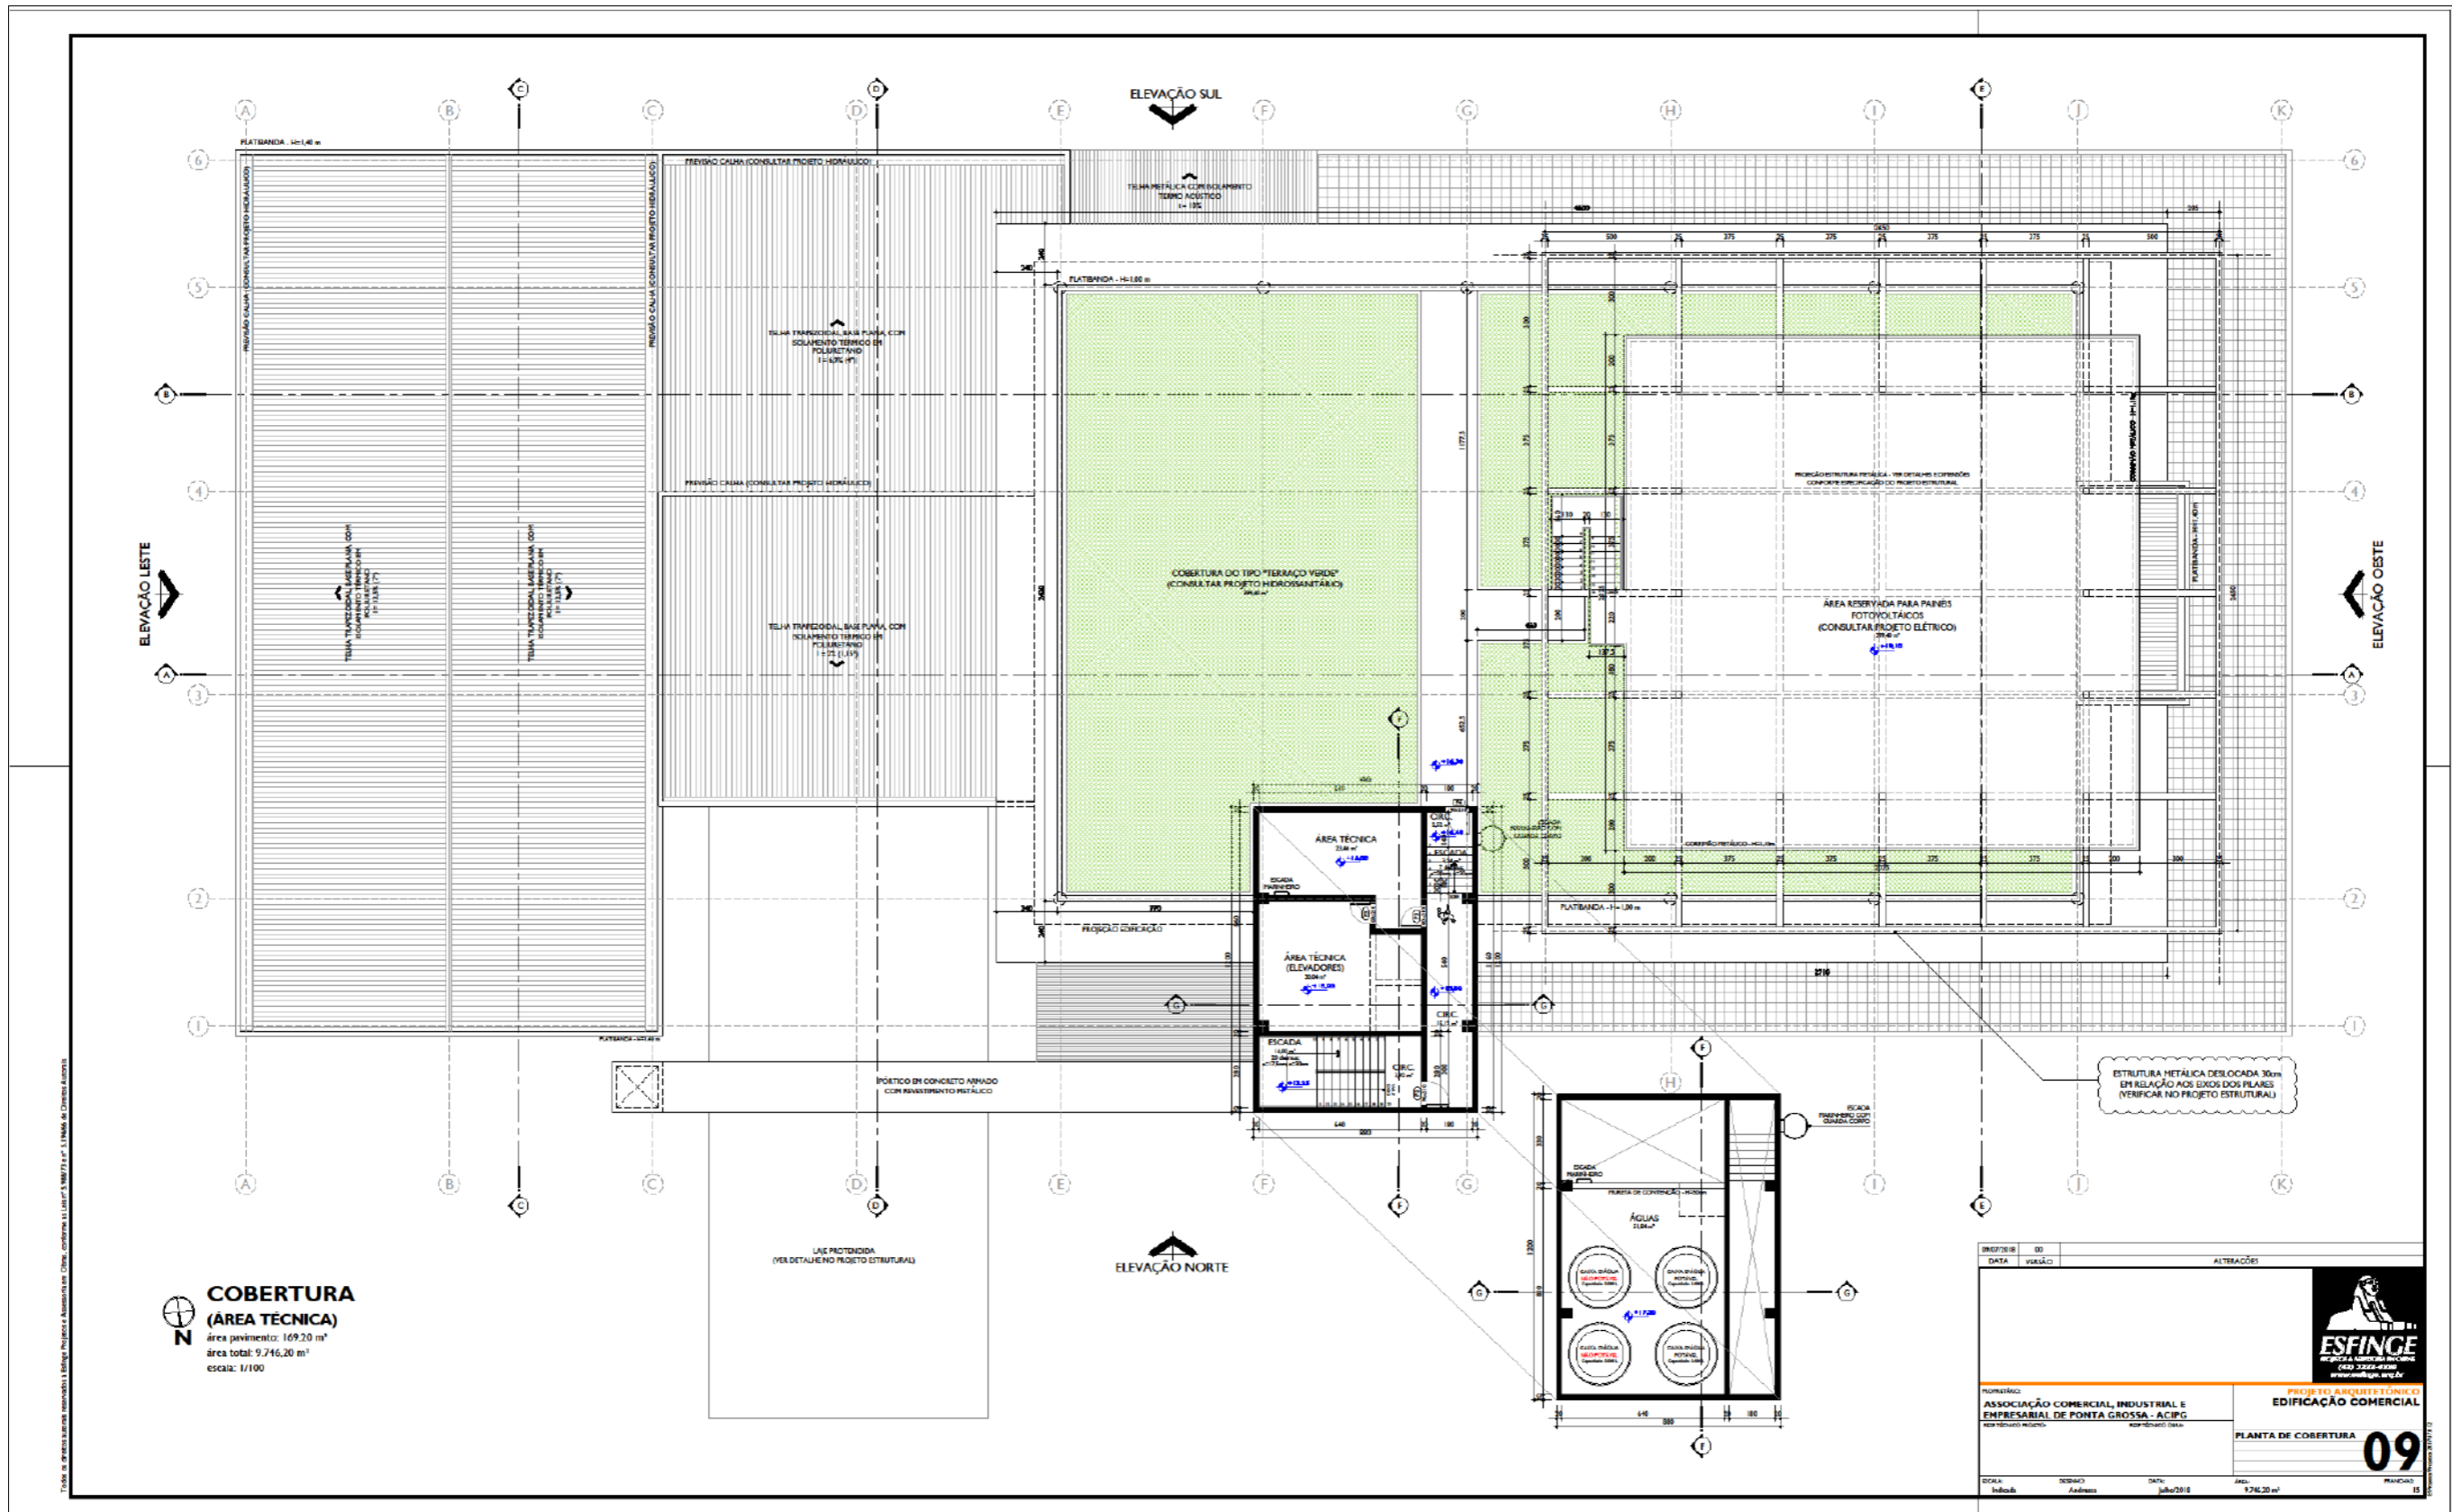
Planta de cobertura. Fonte: Esfinge Arquitetura e Engenharia (2018).
